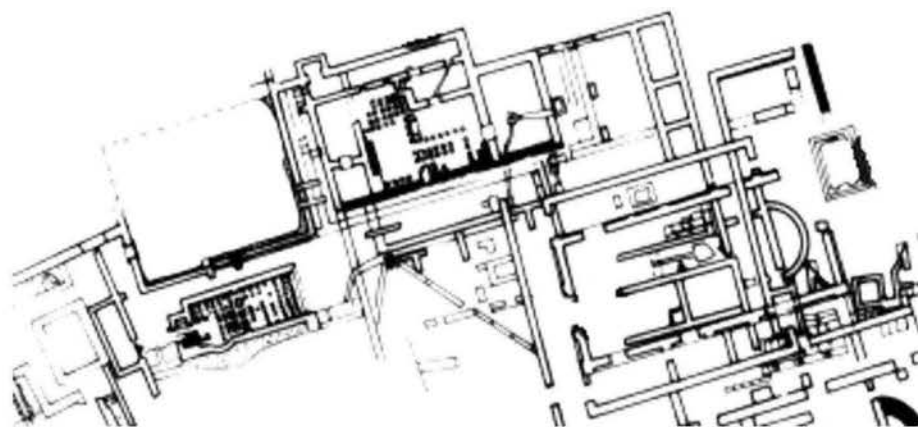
Nesazio, pianta delle terme con la cisterna
